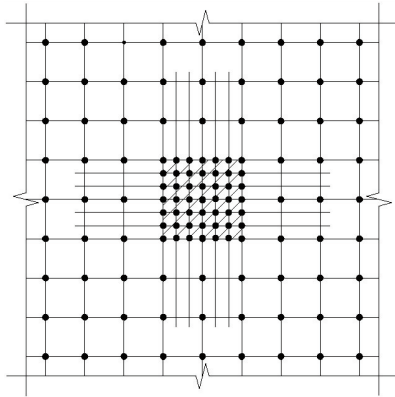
模板支架加密区立杆布置平面示意图
